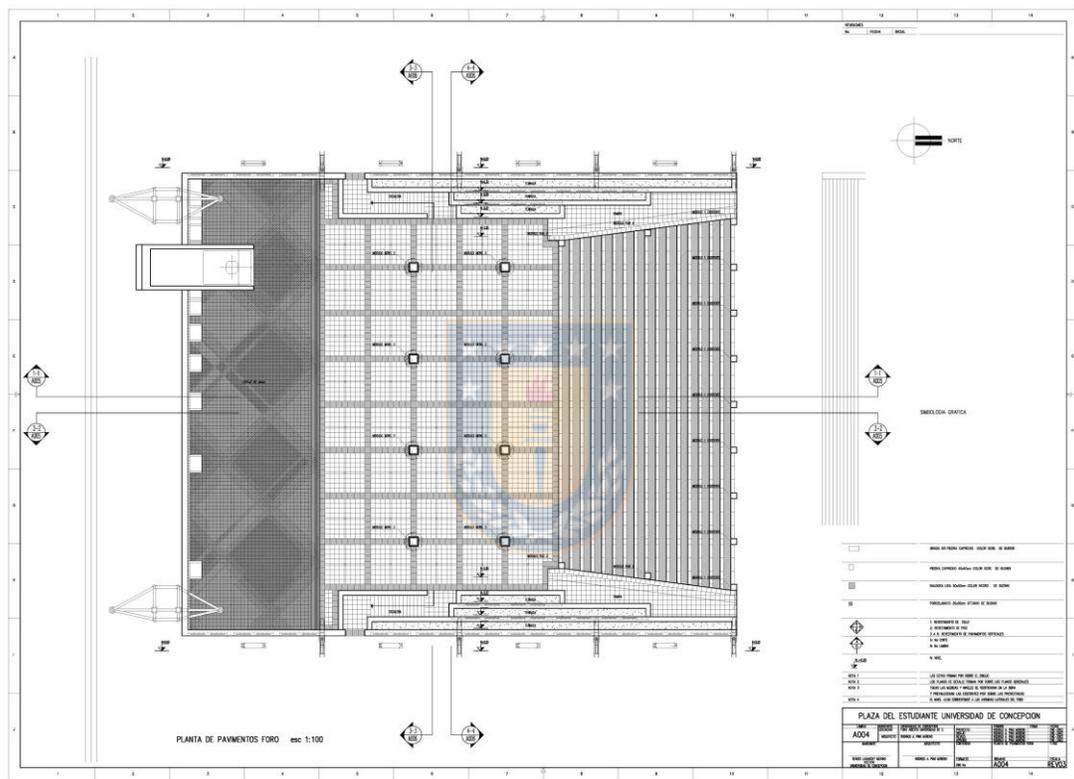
Lamina A004, Archivo Rodrigo Pino Moreno, Plano de Tramas de Pavimentos.
